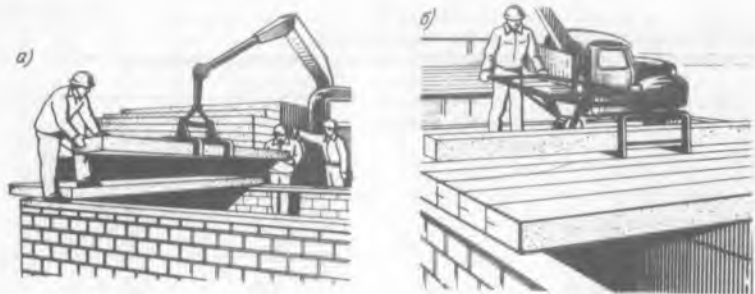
Монтаж плит перекрытия с помощью крана (а) и тележки (б)
